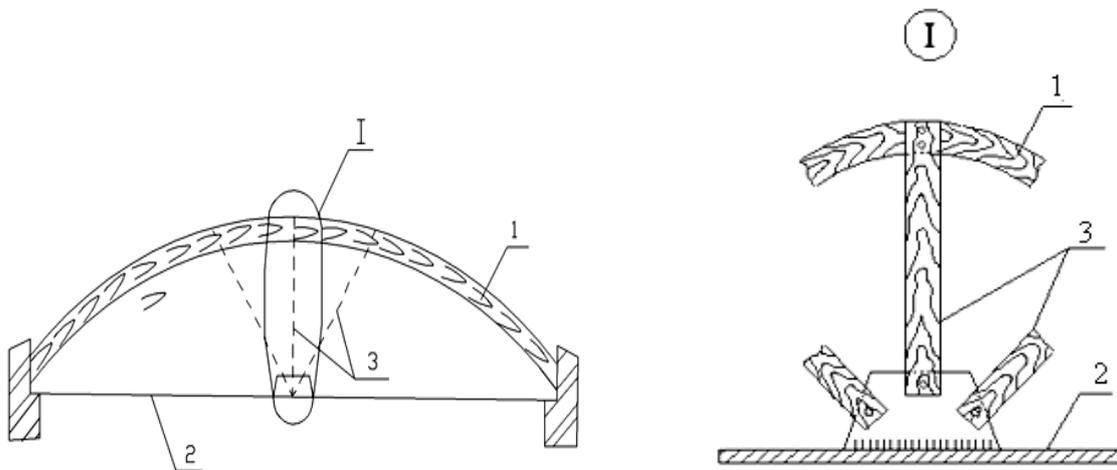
Схема усиления деревянной арки введением решетки из деревянных элементов:
